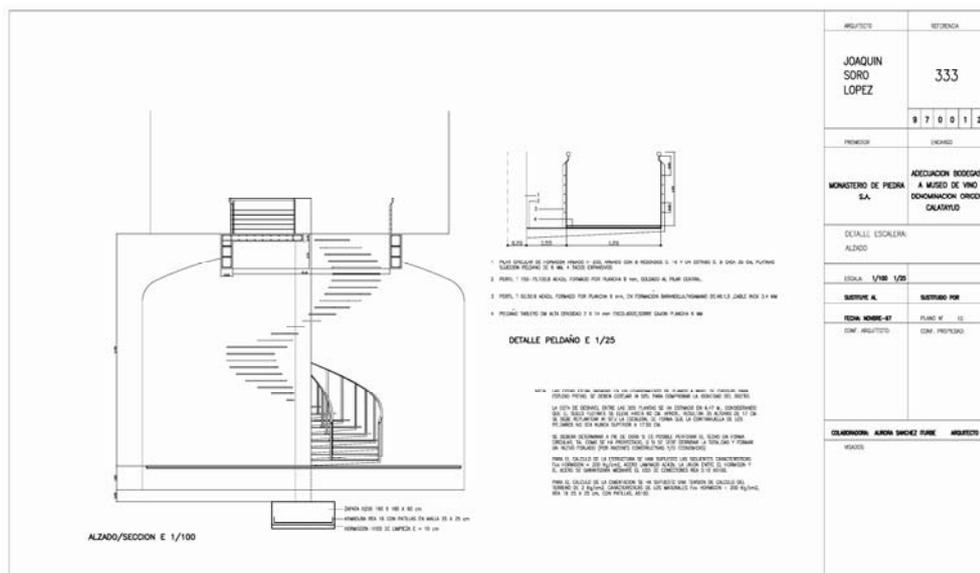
([JAS] Proyecto Nov 1997, plano 10) DETALLE ESCALERA. ALZADO
